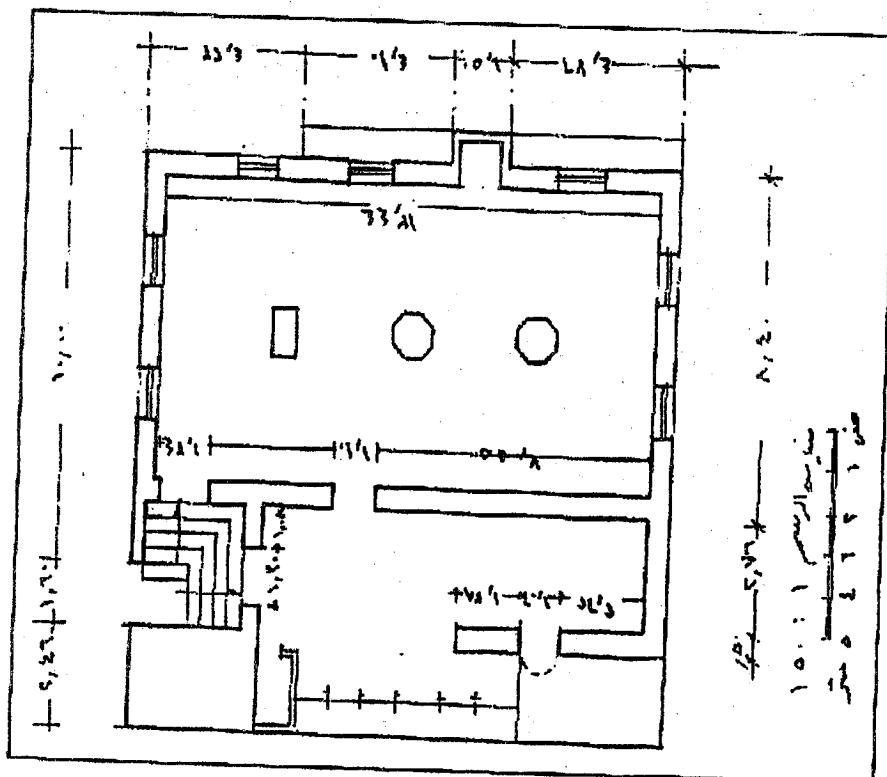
مسقط أفقى لجامع جانغوانى (عن: Chittick Jangwani)
